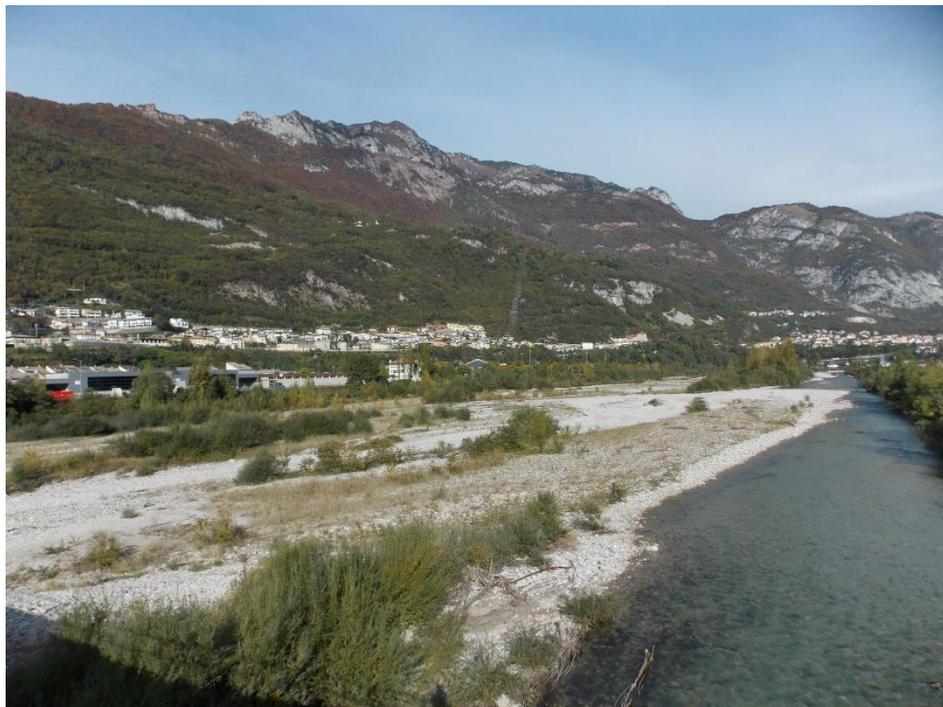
La sponda occidentale del Piave dove passerà la strada in progetto vista dal ponte Campelli (km 7+750), con i centri di Longarone (a sinistra) e Castellavazzo (sul fondo a destra)
